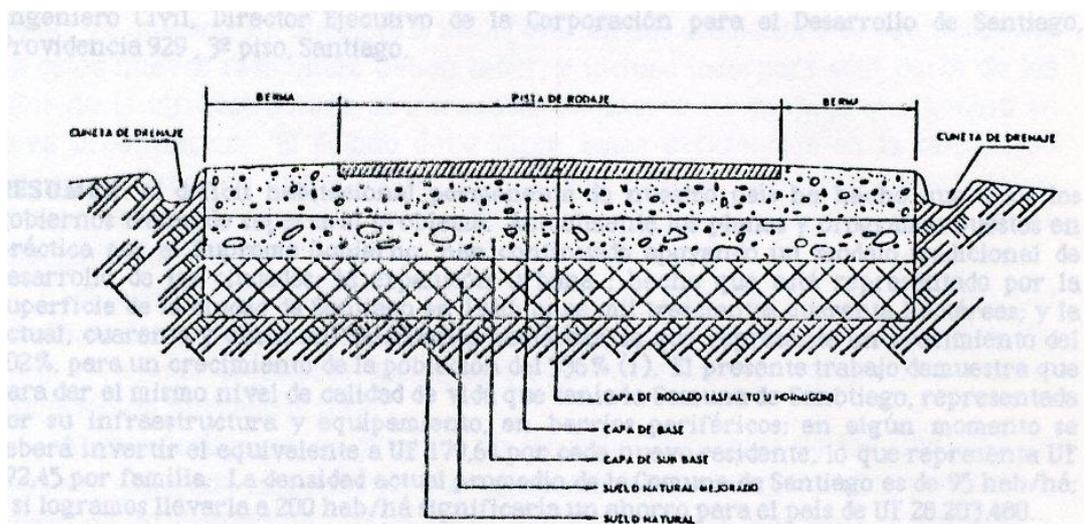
SECCION TRANSVERSAL DE UN PAVIMENTO
